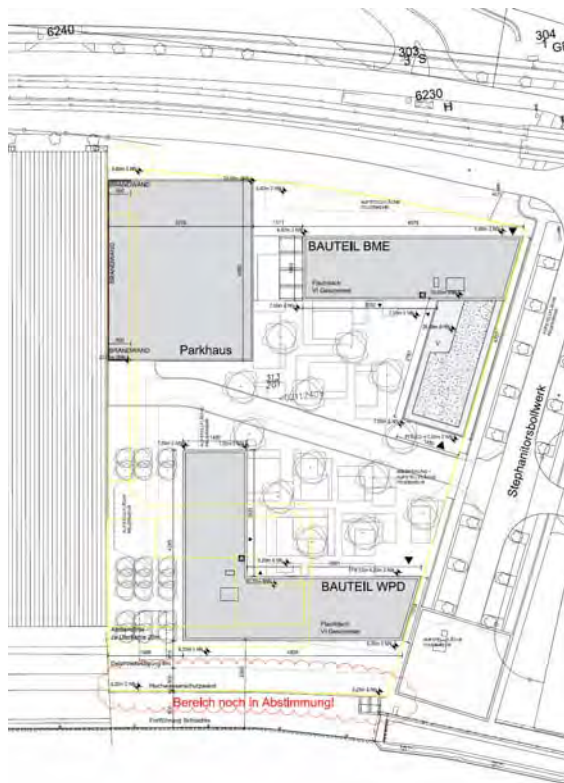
Lageplan der Gebäude BME und WPD Abb. 16 Ansicht des BME Gebäude
